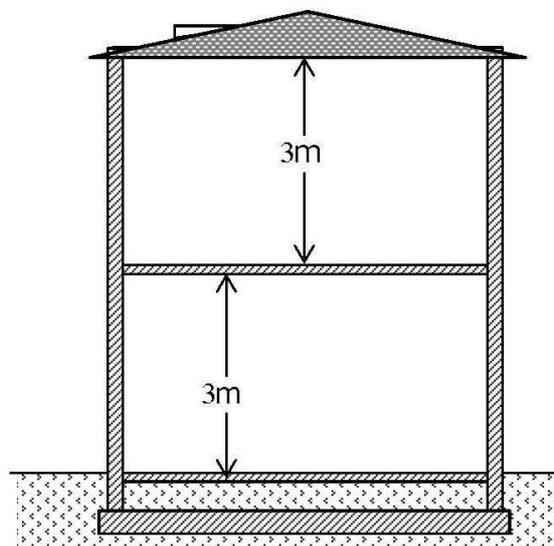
Exemple d'un bâtiment de type 1 : maison individuelle R+1
